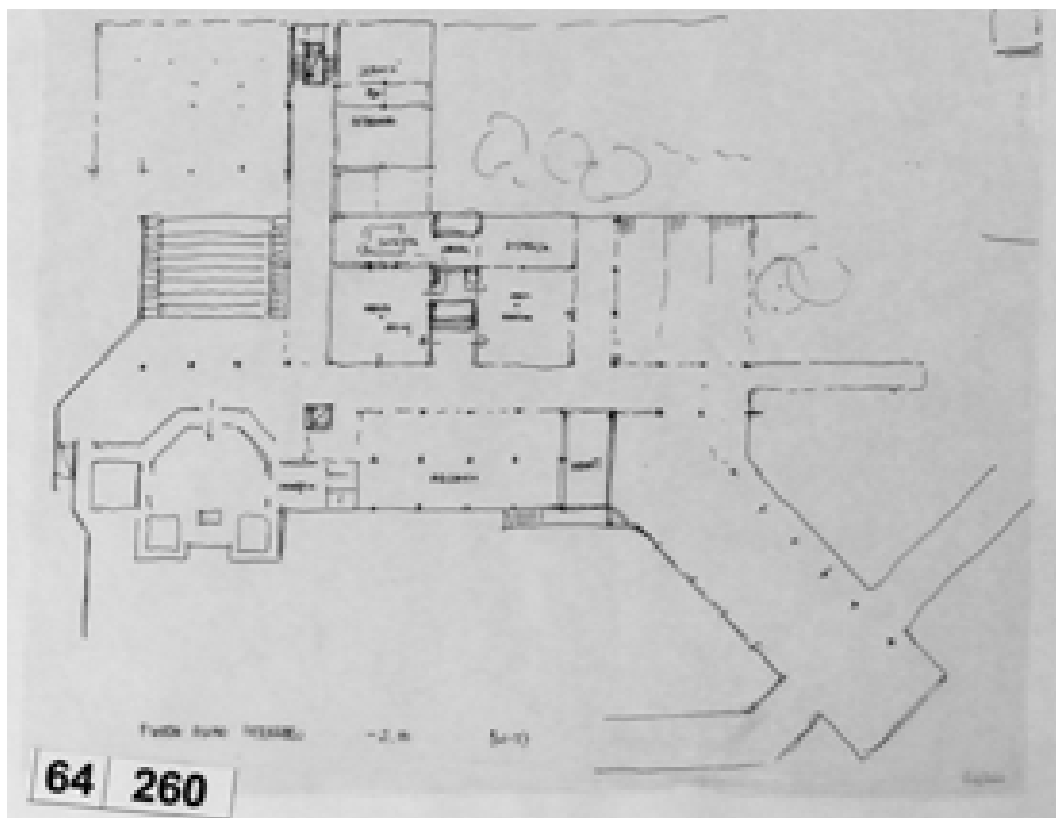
Pianta piano interrato -2,00, stato futuro – 09/11/1993 (AABS-64_260)
